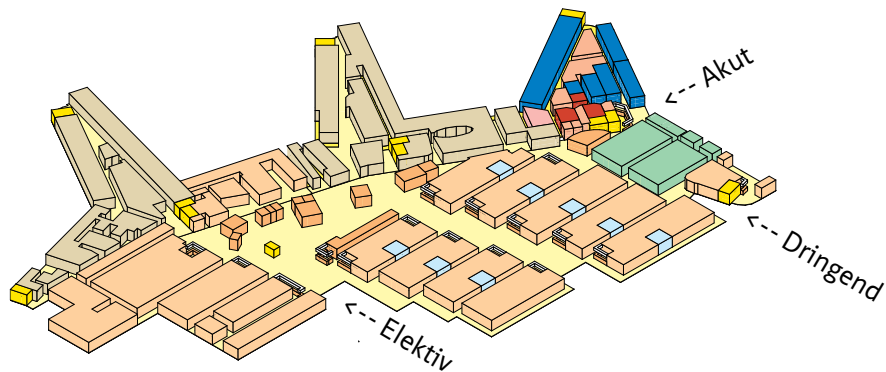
Grundriss mit Standort der Eingänge zur akuten, dringenden und elektiven Versorgung.
